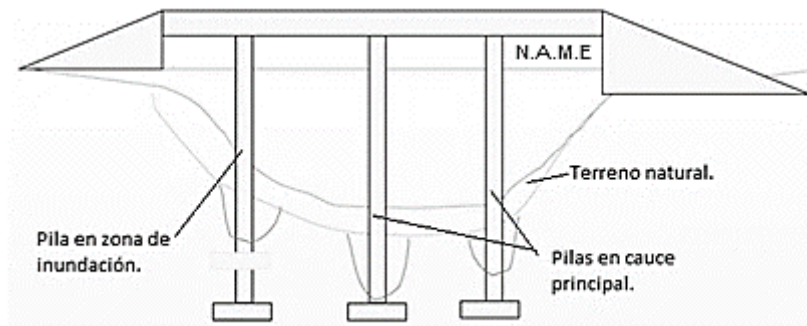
10 Elevación de las cimentaciones de las pilas en el cauce principal.
